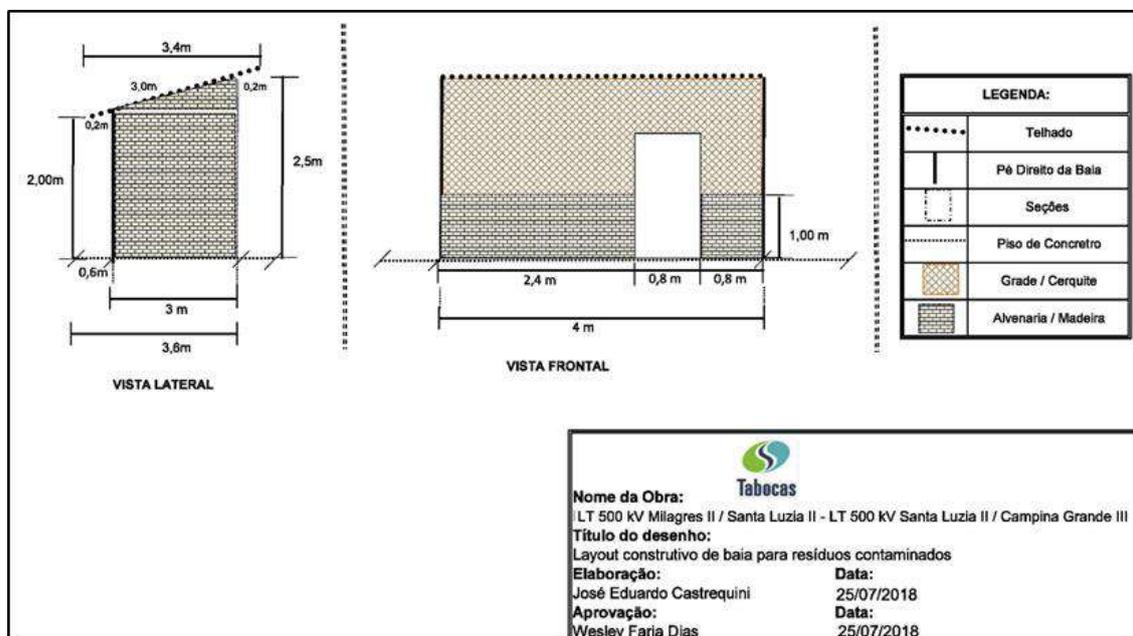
Modelo de Layout construtivo de baia de resíduos contaminados.
